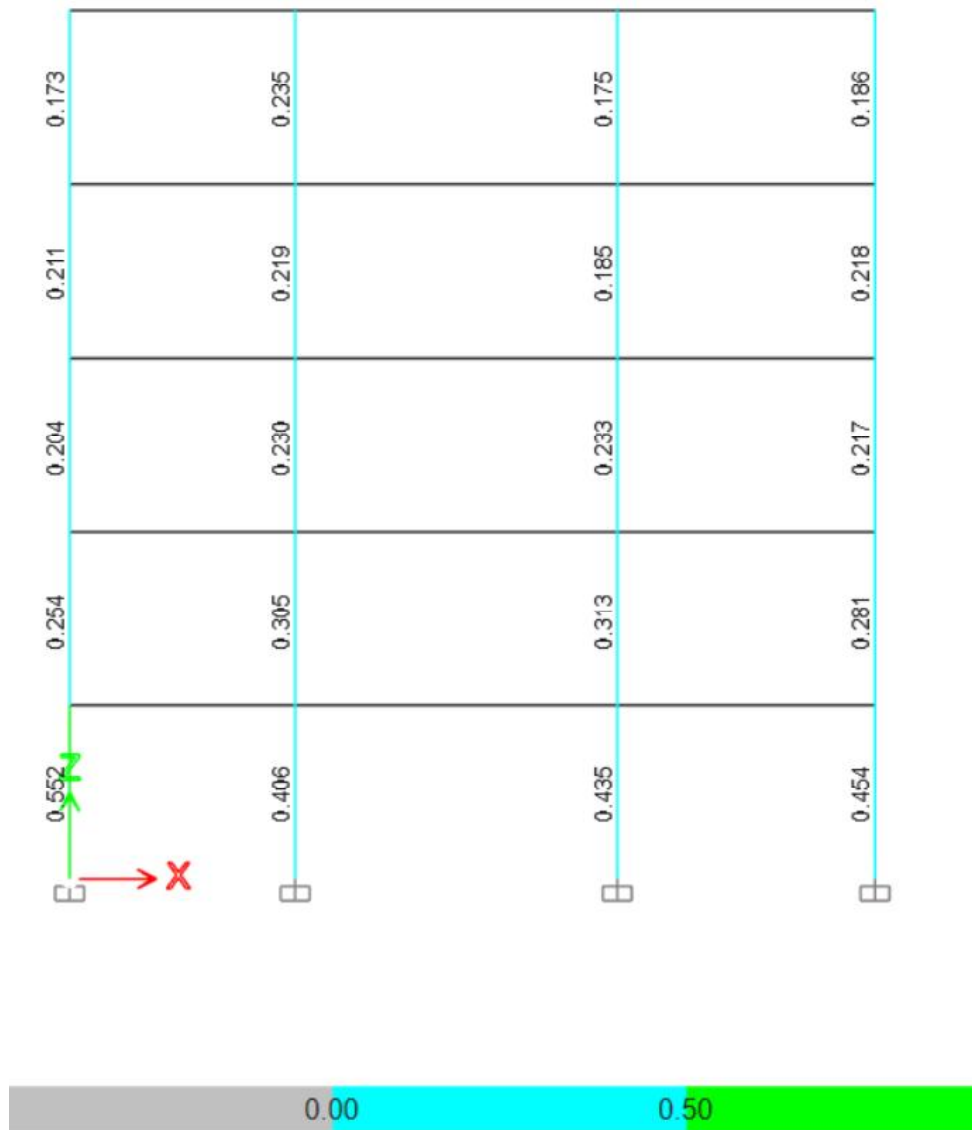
Radio de capacidad columnas - Estructura 5 Pisos
